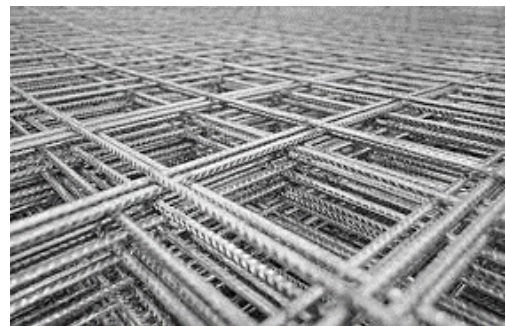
Malla Electro soldada . Fuente: Monolit.
